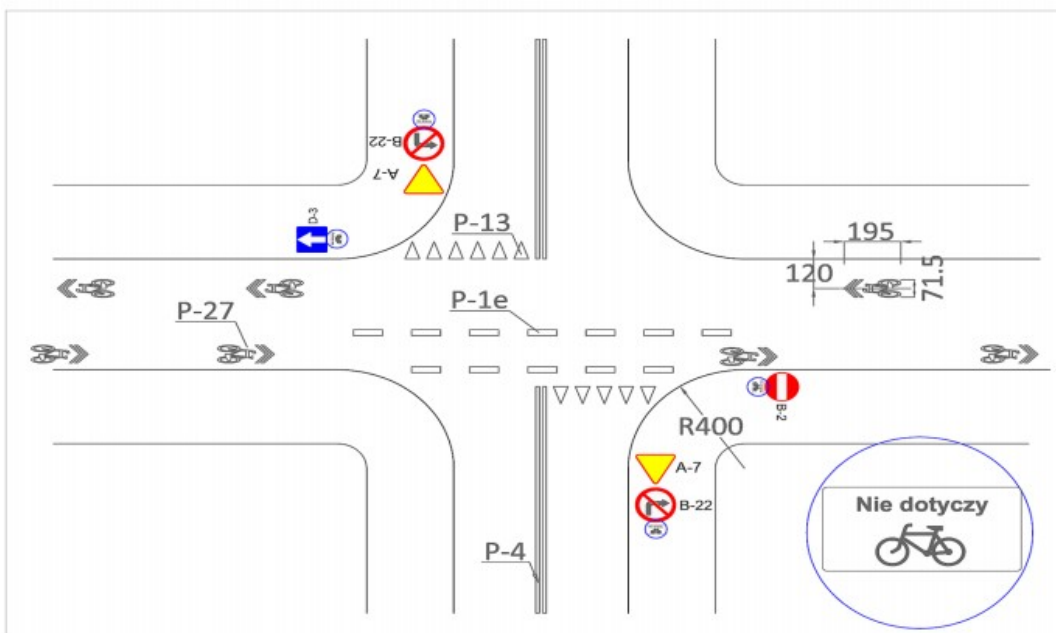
Jednokierunkowa droga z ruchem „wahadłowym”.
